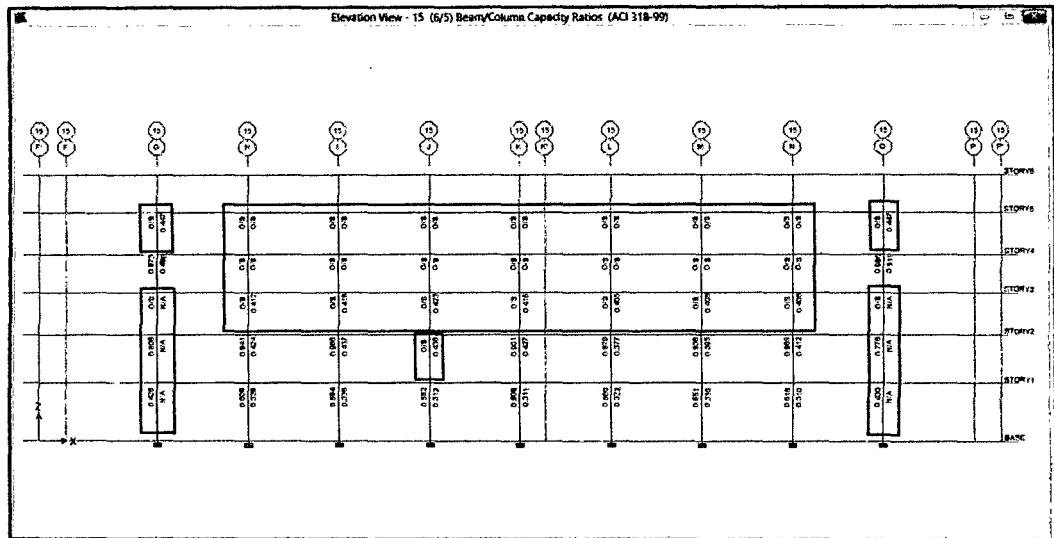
Ubicación de Fallas en columnas – Eje 15
